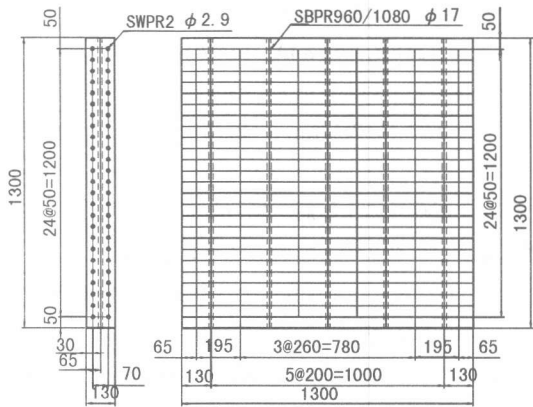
2PC 配筋図例 (2PC-1~6) (mm)
